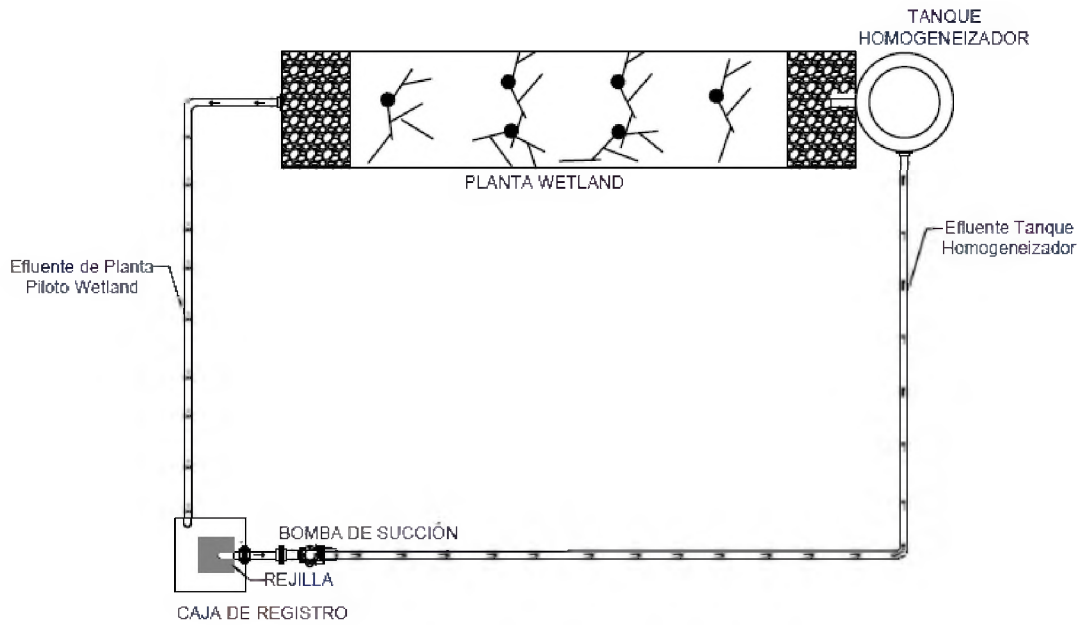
Planta Piloto con Caña Guadua. Vista en Planta.
